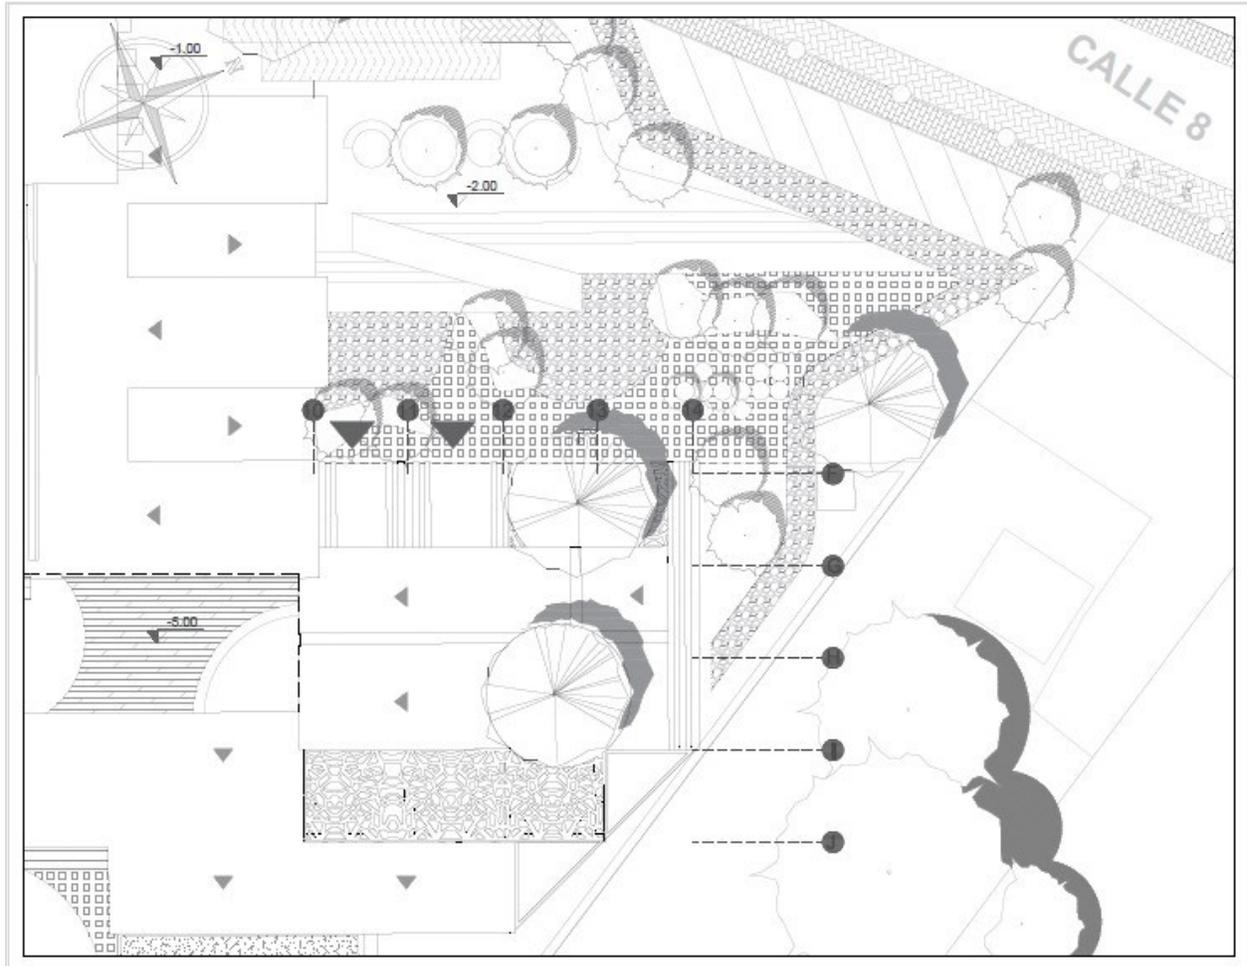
Planta Cubierta Edificación 4 Capilla (Rubiano, 2020)
